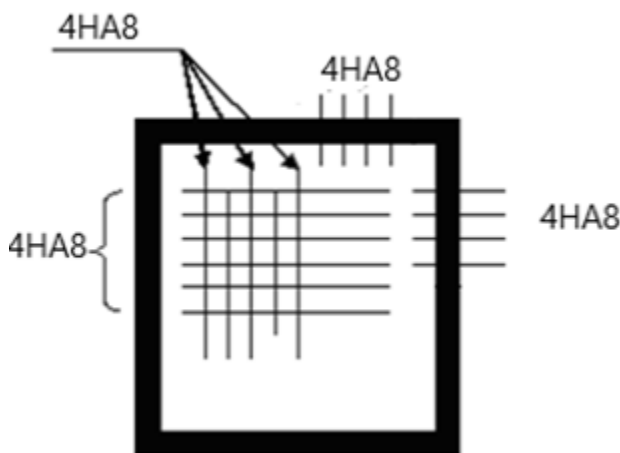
schéma de ferrailage de la dalle du locale des machines.
